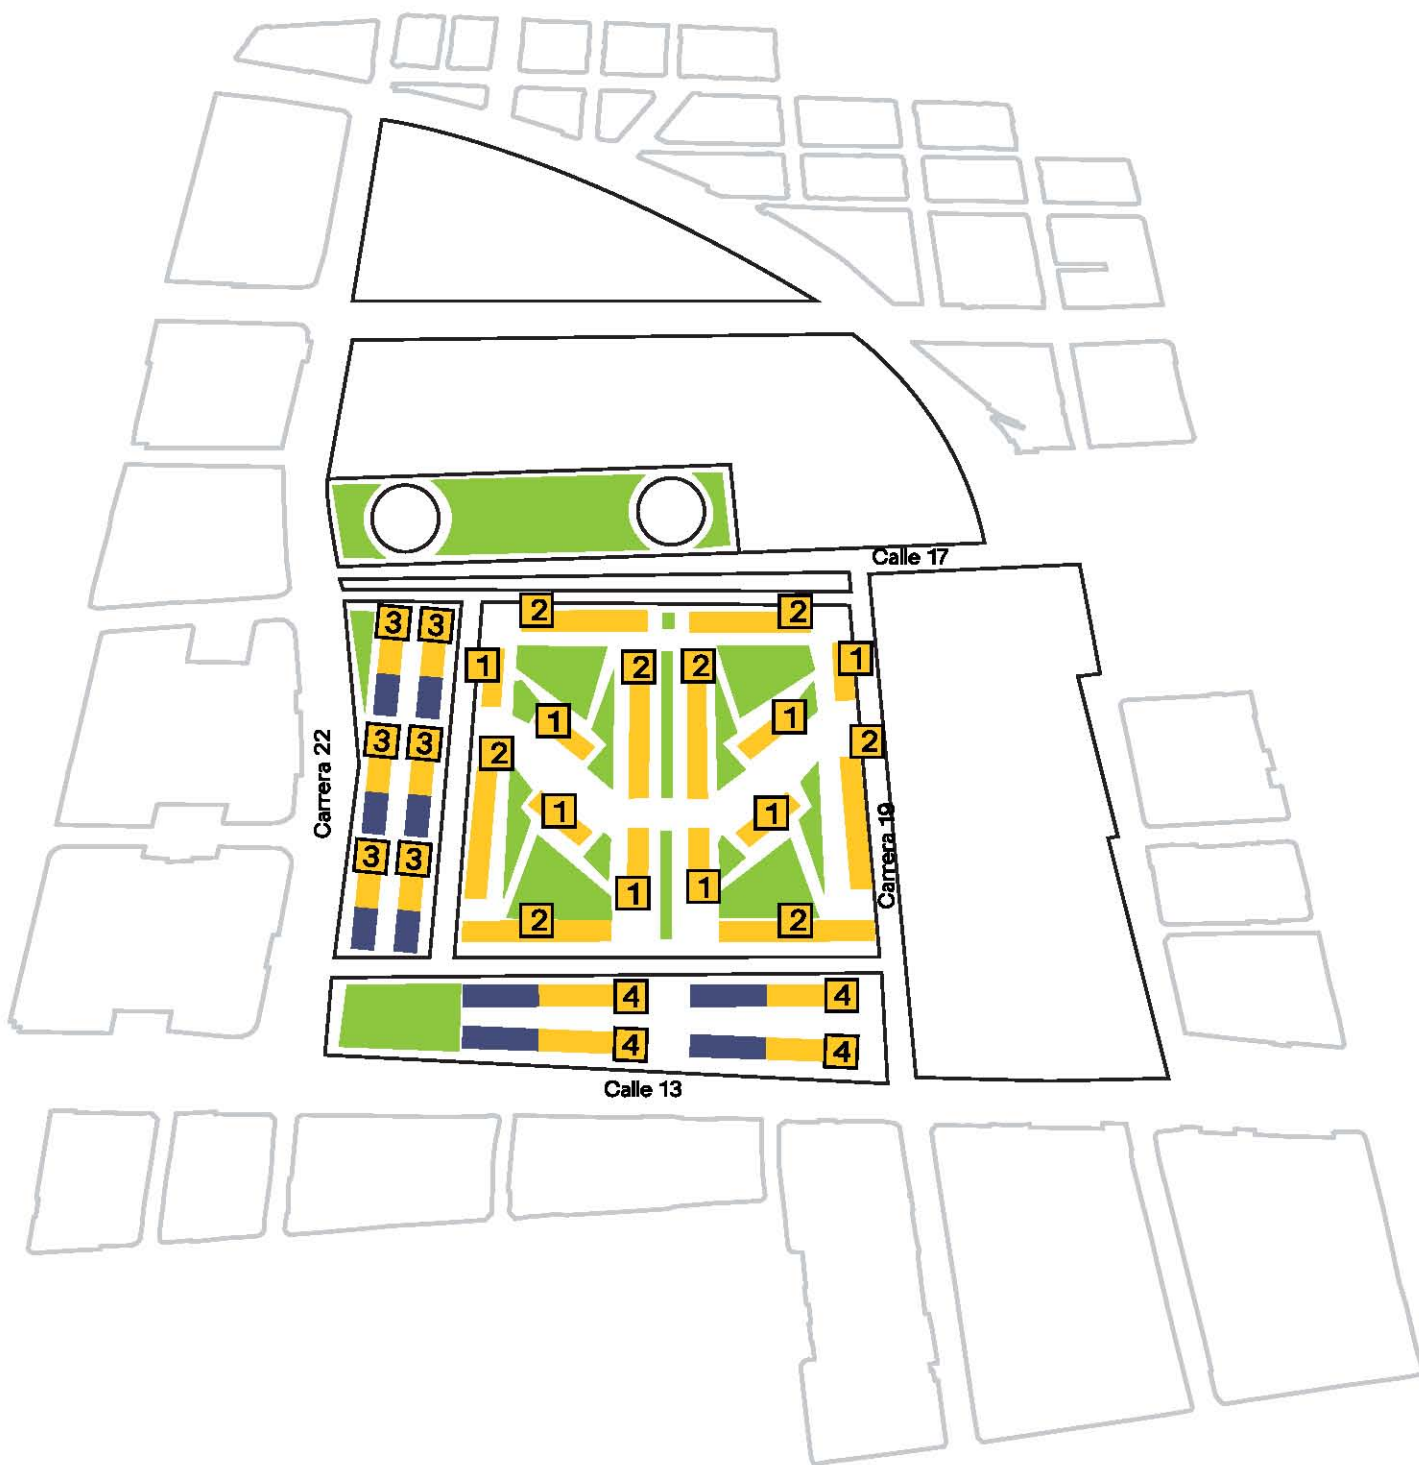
Plano de conjunto de la propuesta de emplazamiento de El Listón. - Edificios habitacionales y mixtos
